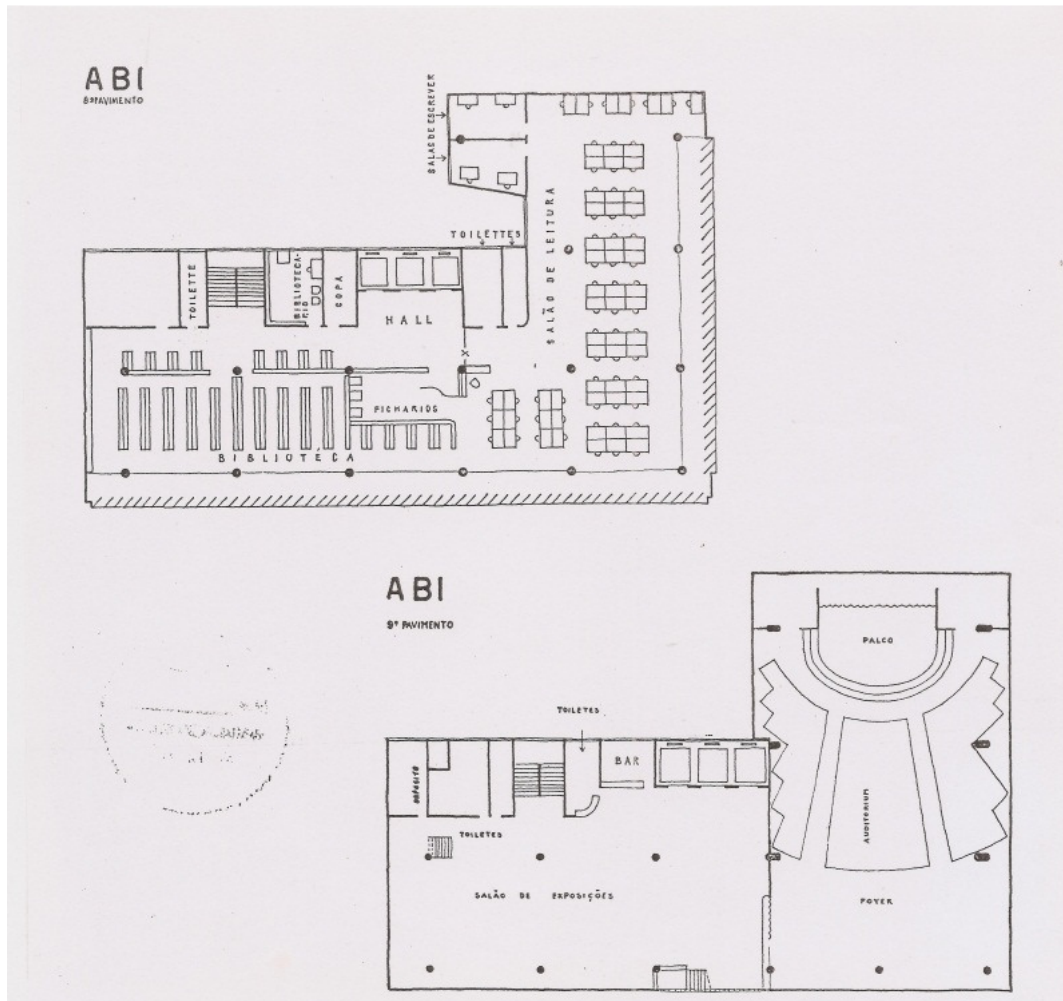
H – Plantas baixas do oitavo pavimento (biblioteca) e nono pavimento (auditório e sala de exposições)
